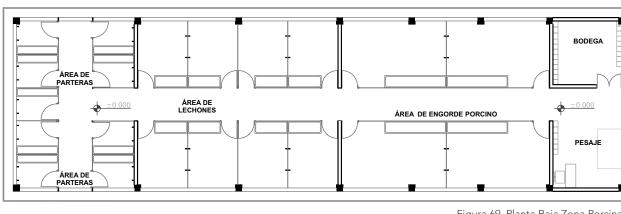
Planta Baja Zona Porcina Fuente: Autor
